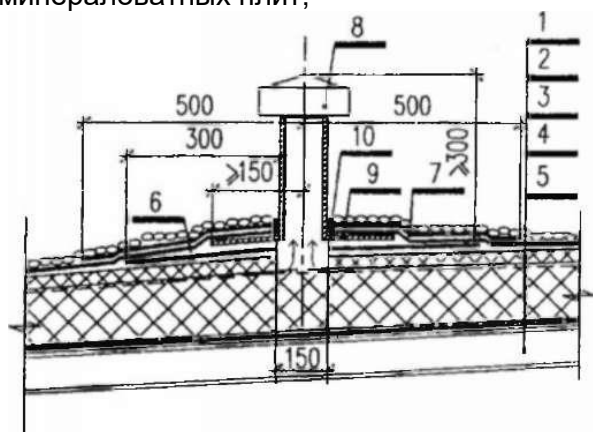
Установка аэратора на кровле по стальному профнастилу и теплоизоляции из жестких минераловатных плит
